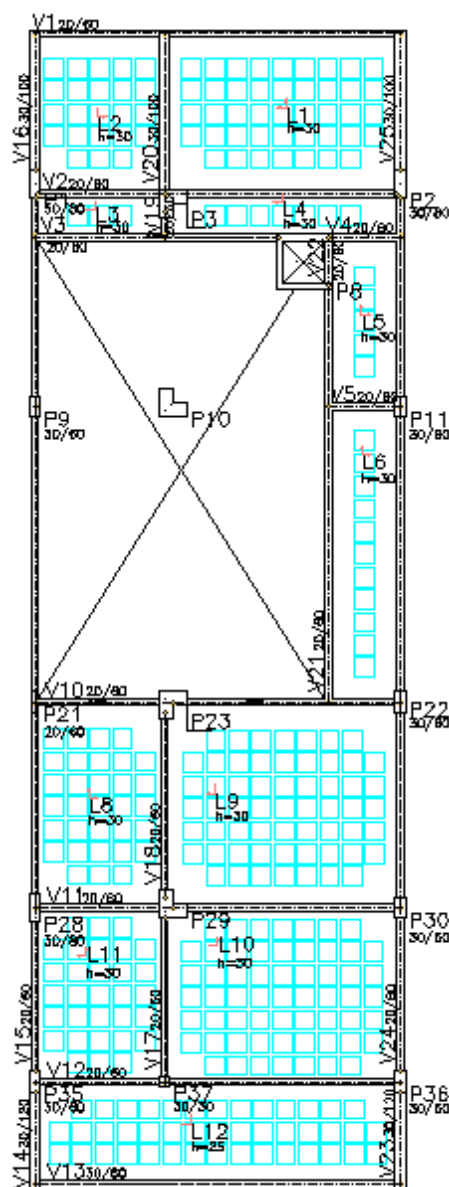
Desenho de fôrmas com cubetas do pavimento Biblioteca da Solução com Laje Nervurada
